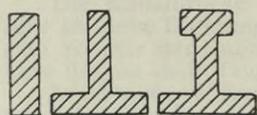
Querschnitte gußeiserner Brückenbalken.
